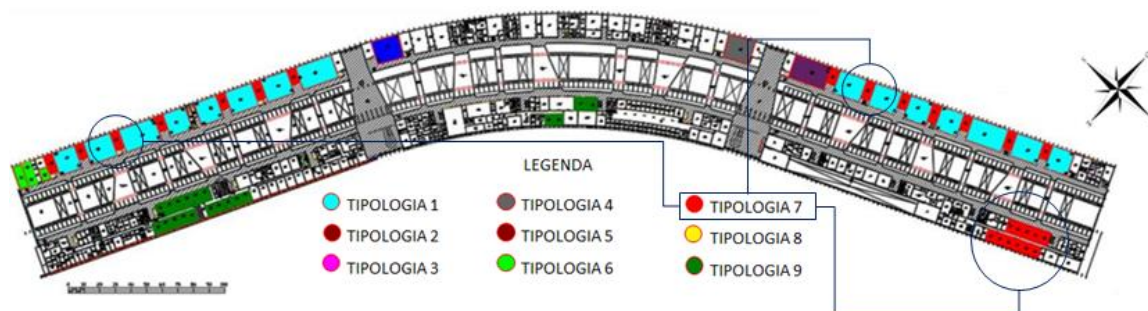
Planta baixa pavimento térreo ICC/UnB.
